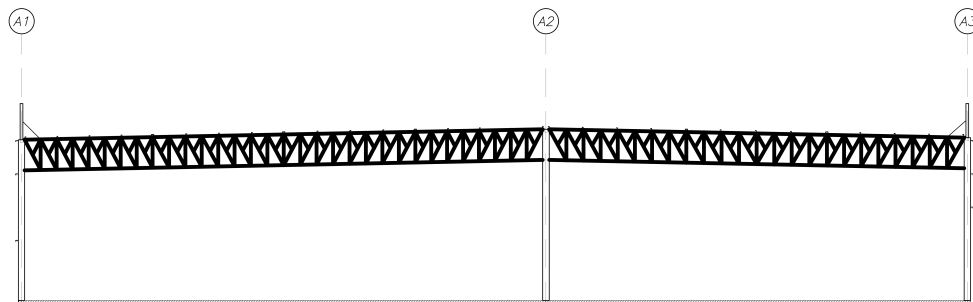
Elementos con plastificaciones longitudinales en armaduras
